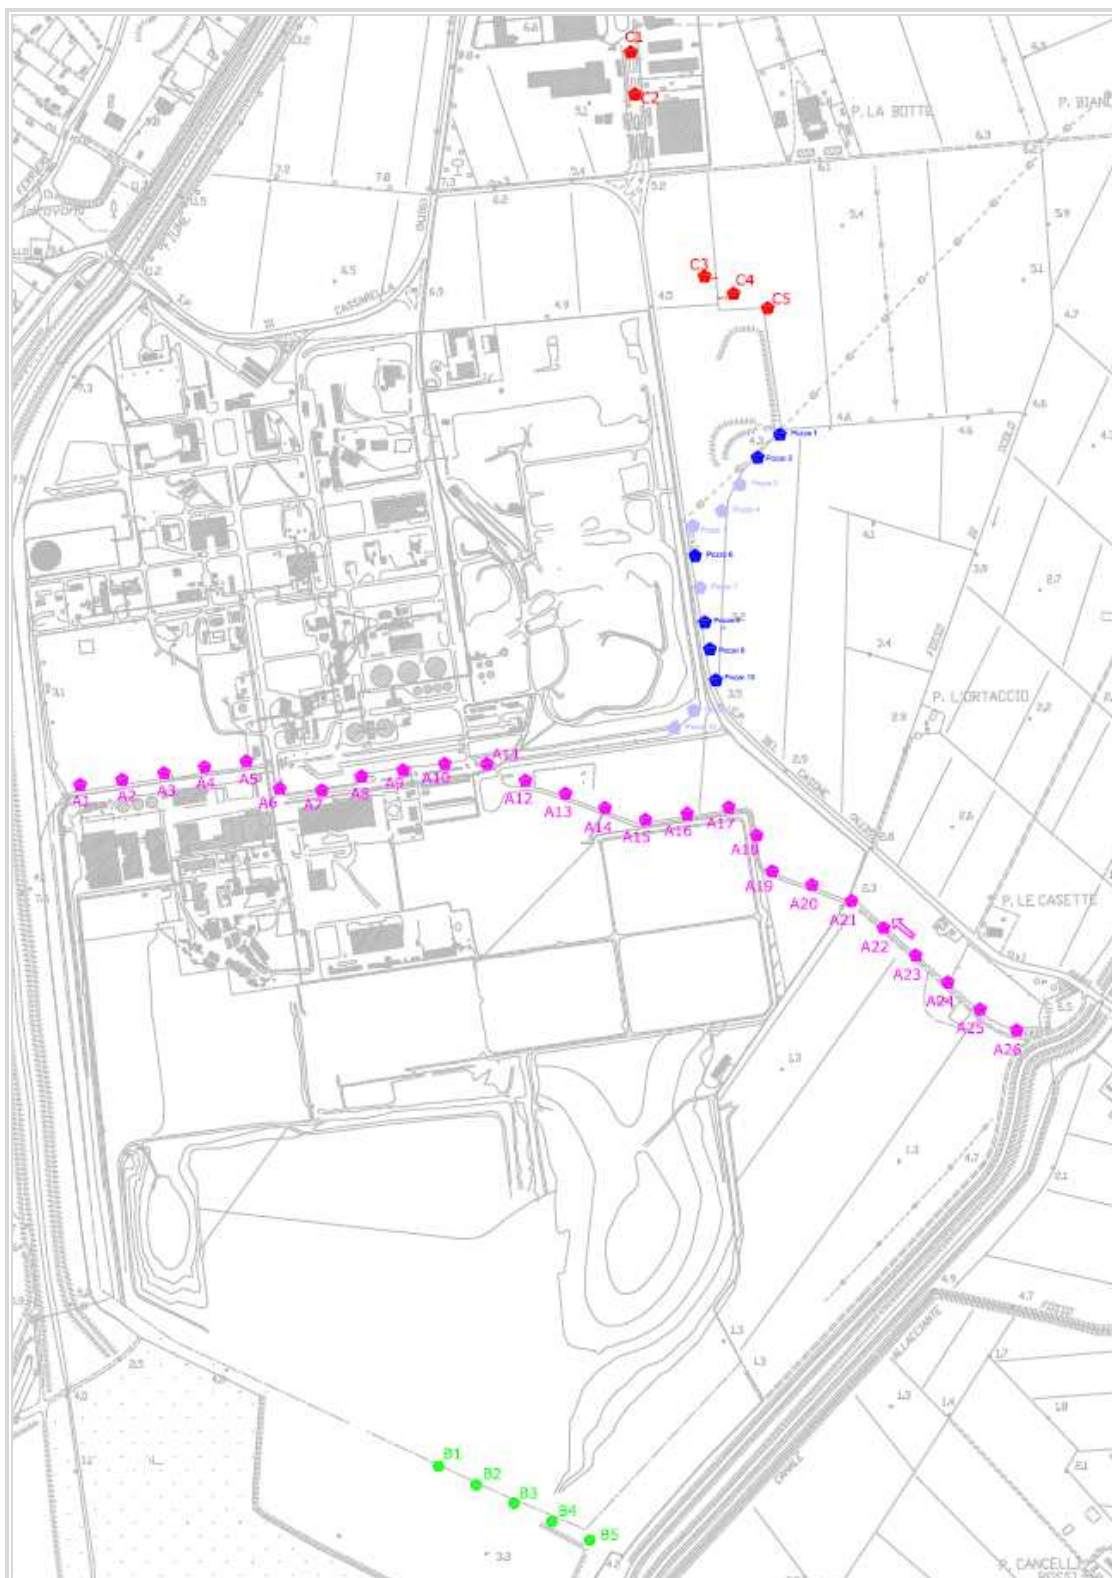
Stralcio planimetrico con ubicazione barrieramento idraulico: in rosso la nuova linea di progetto in zona La Botte; in azzurro/blu i pozzi della barriera esistente mantenuti (in azzurro i pozzi improduttivi, in blu quelli produttivi); in verde la nuova linea in zona Padule; in magenta la nuova linea in zona Casone. Ad ogni punto (ad esclusione della linea esistente, in azzurro/blu) corrisponde n.1 cluster, costituito da n.2 pozzi accoppiati
